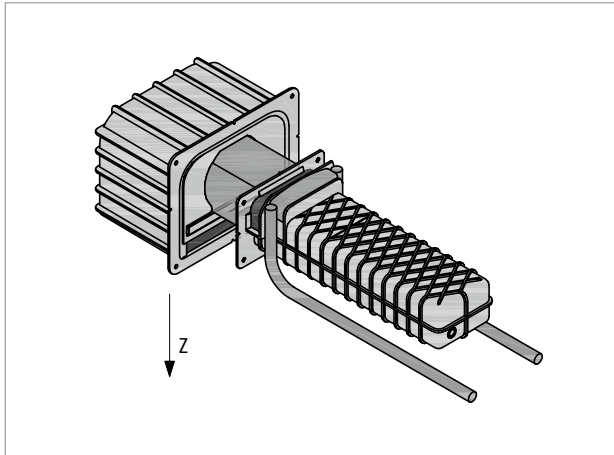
Schöck Tronsole® Typ Q: 3D-Ansicht mit Achsbezeichnung
